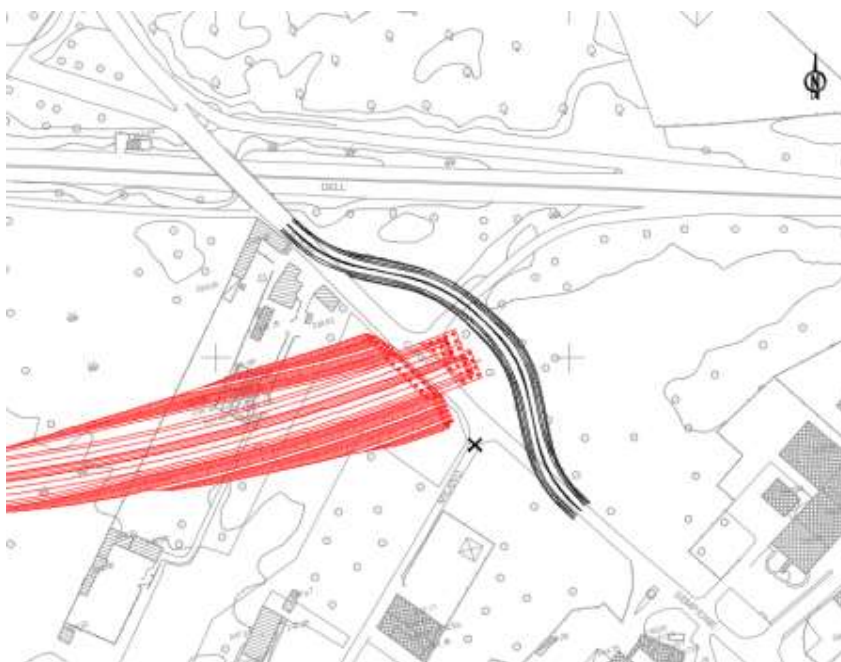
Planimetria deviazione provvisoria su C.so Sempione (in nero) e aree in lavorazione (in rosso) prevista durante la FASE 3
